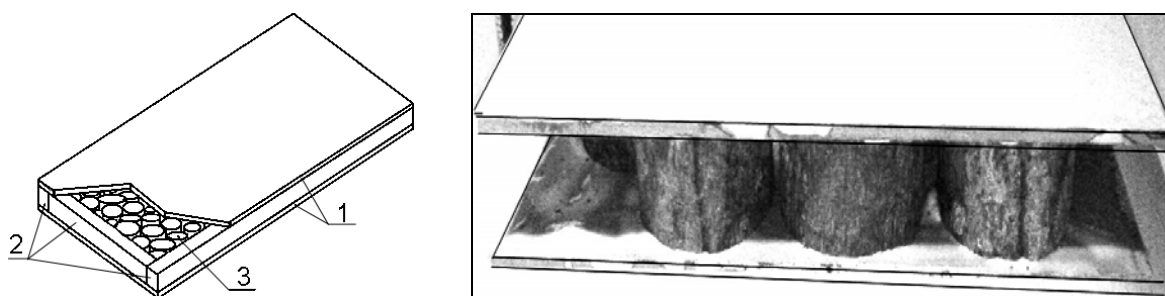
Трехслойный строительный щит: 1 – обшивки; 2 – бруски обвязки; 3 – торцовый заполнитель из круглой тонкомерной древесины
